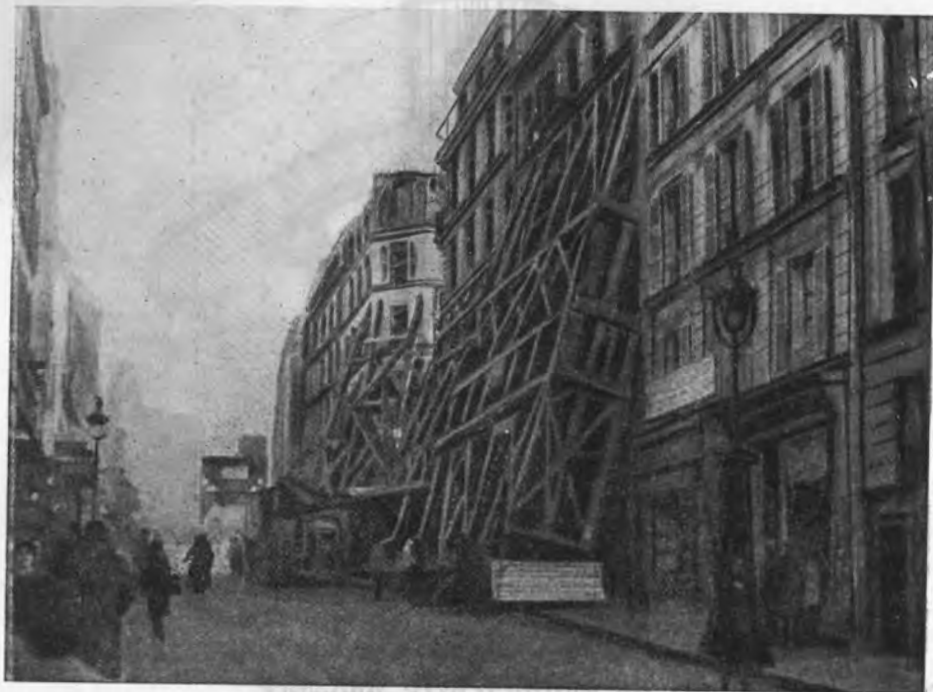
Укрепление подкосами многоэтажных домов на Рю де Бельвилль при прокладке под ними тоннелей метрополитена парижским способом.
